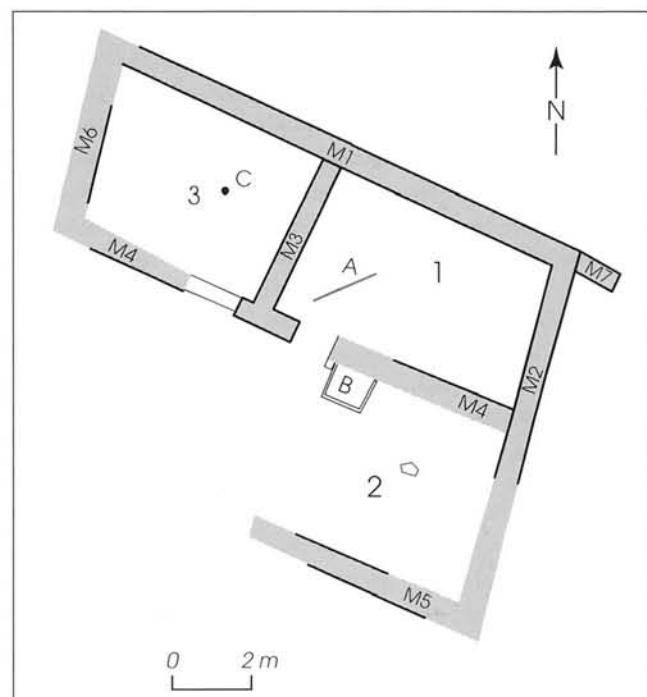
LE MUY, Barresse. Plan de la ferme (Françoise Laurier, CAV).
